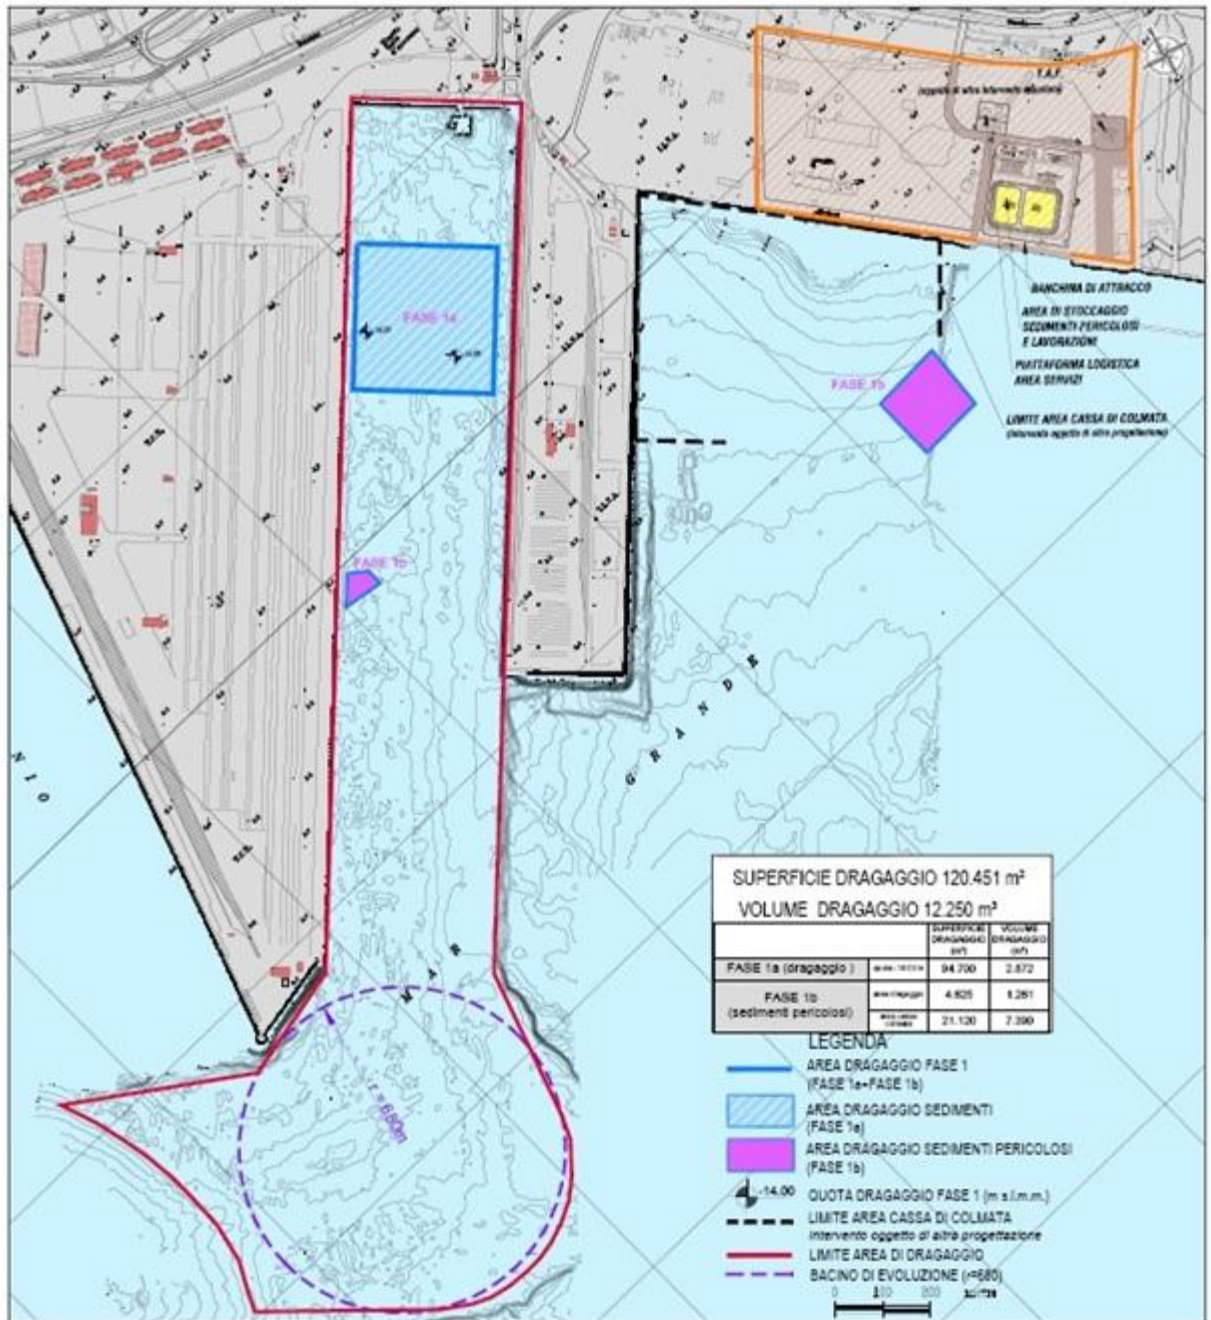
Fase 1a e 1b del progetto di dragaggio Darsena Polisettoriale
